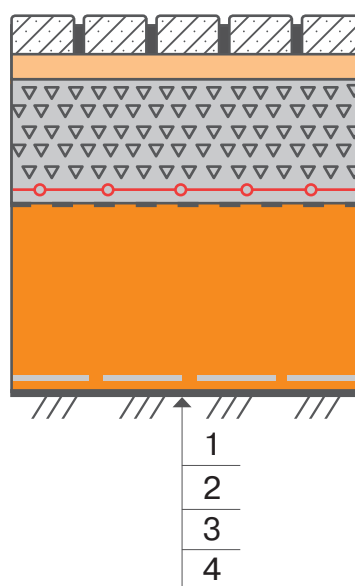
Конструктивная схема дорожной одежды с покрытием из плит бетонных тротуарных BRAER Группы VI
